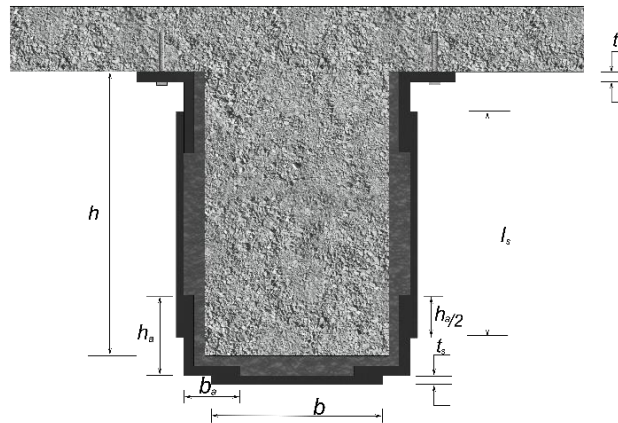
a - Sección transversal de viga encamisada con ángulos y soleras
